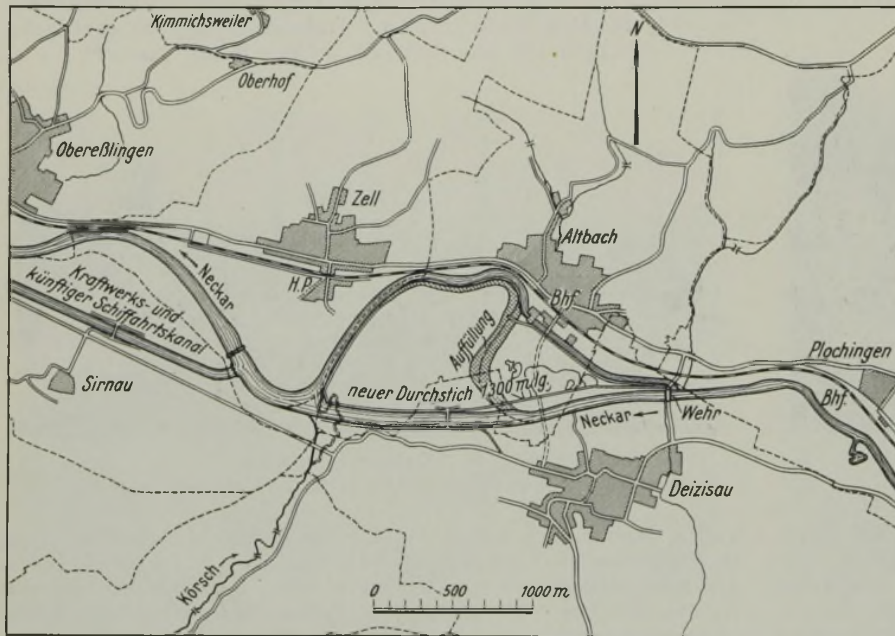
Lageplan der Staufstufe Altbach-Plochingen (Durchstich bei Deizisau).
